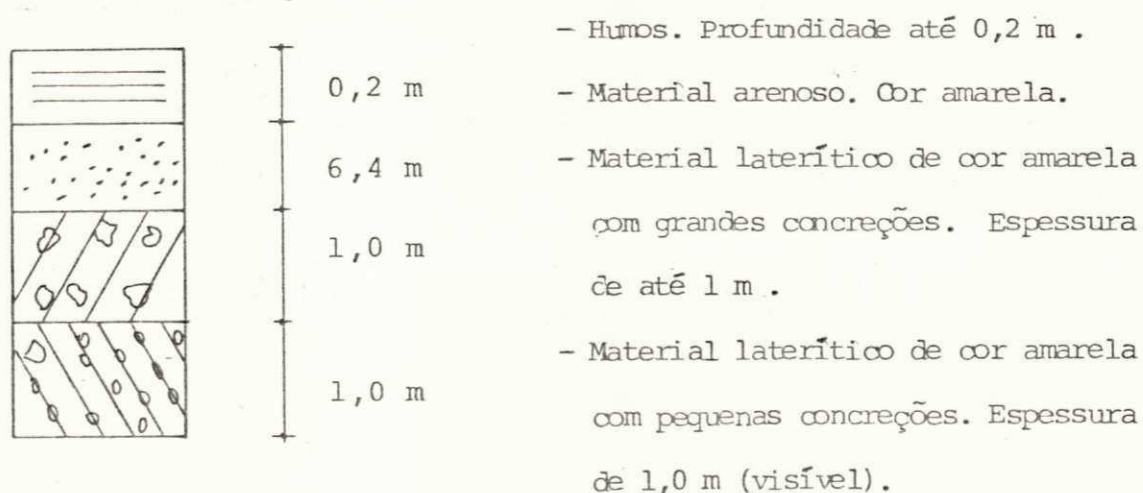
Perfil Esquemático da Jazida MO-Pa.
